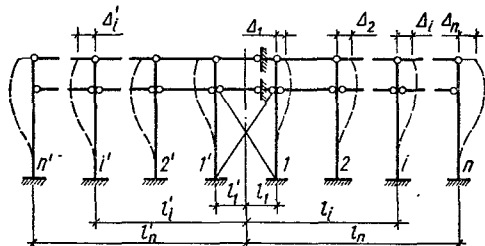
Основная система продольной рамы каркаса здания, оборудованного мостовыми кранами.
